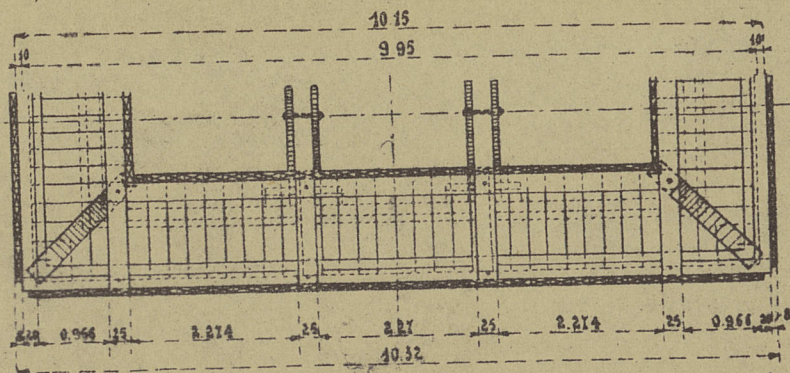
Crèche basse du pont de Rouen pendant la construction d'une pile sur caisson forcé.
